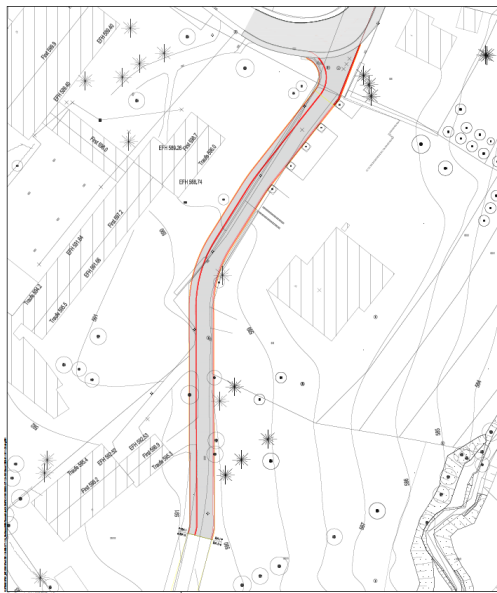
Erschließung Stollenau Lageplan (SWECO GmbH Stuttgart)
